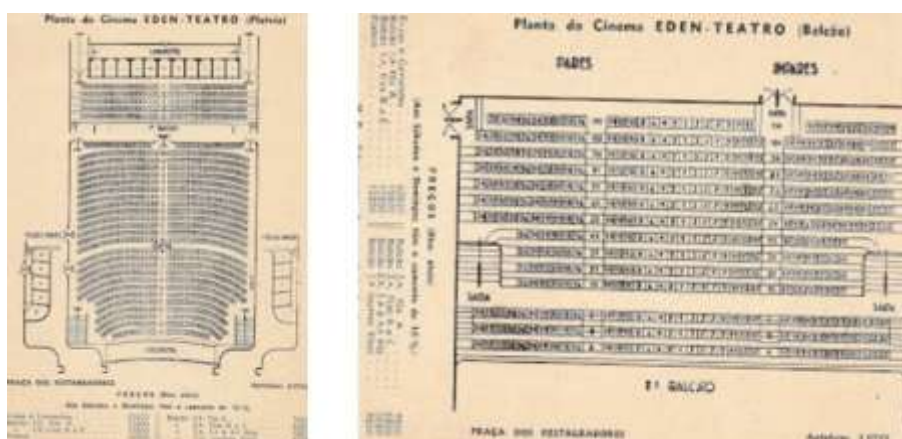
Planta original da plateia, 1º e 2º balcão. (Figueiredo 2010)
